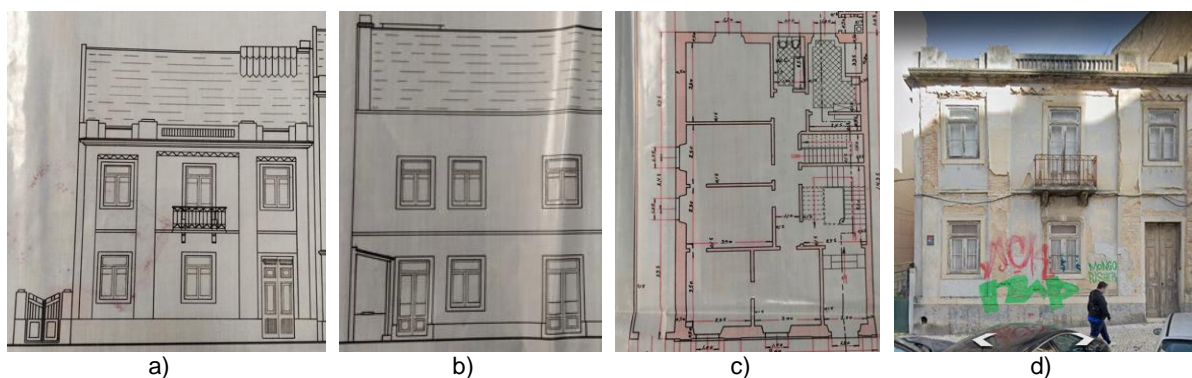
Edifício da rua Augusto Gil n.º 26: a) fachada principal; b) fachada tardoz; c) planta do rés-do-chão e d) imagem atual do edifício (Google Earth, Junho 2022)
